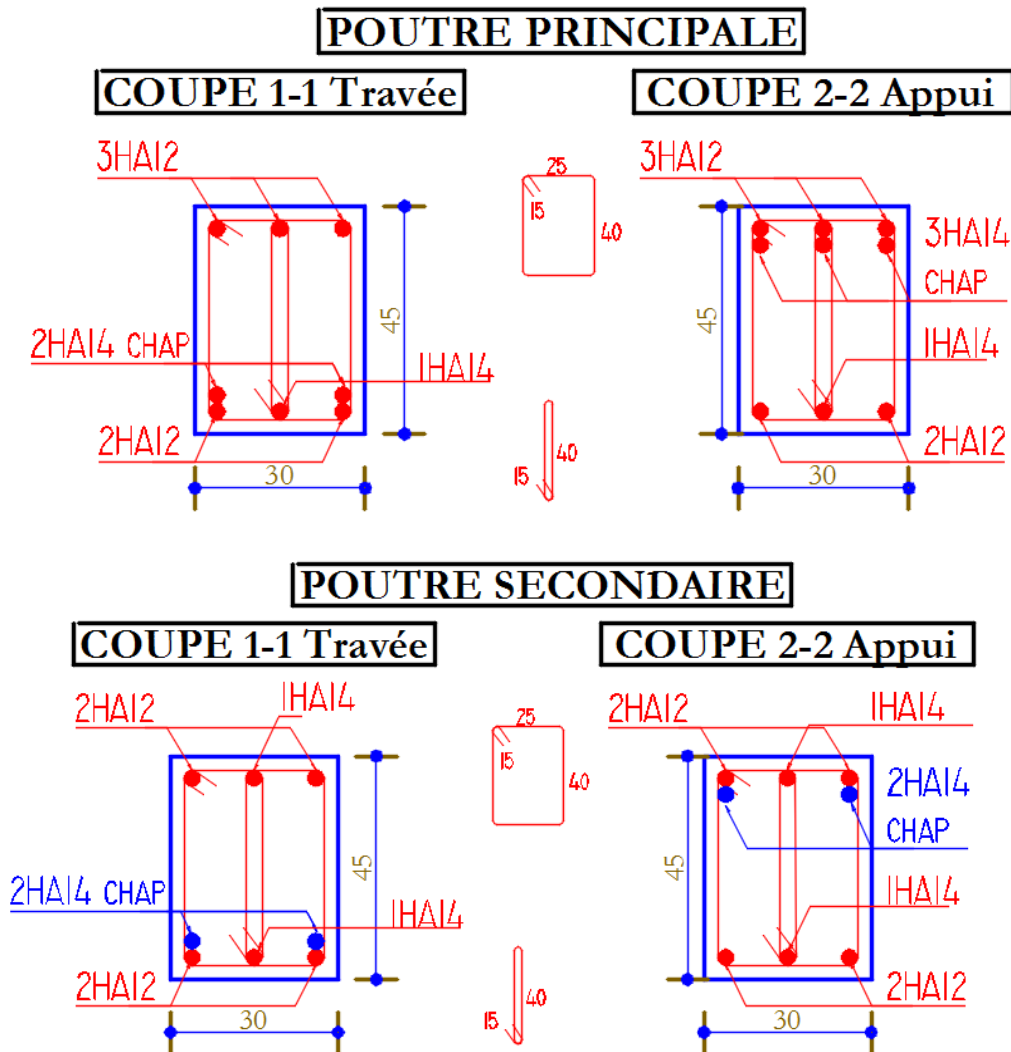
Schémas de ferraillage de la poutre principale et secondaire des étages courants
